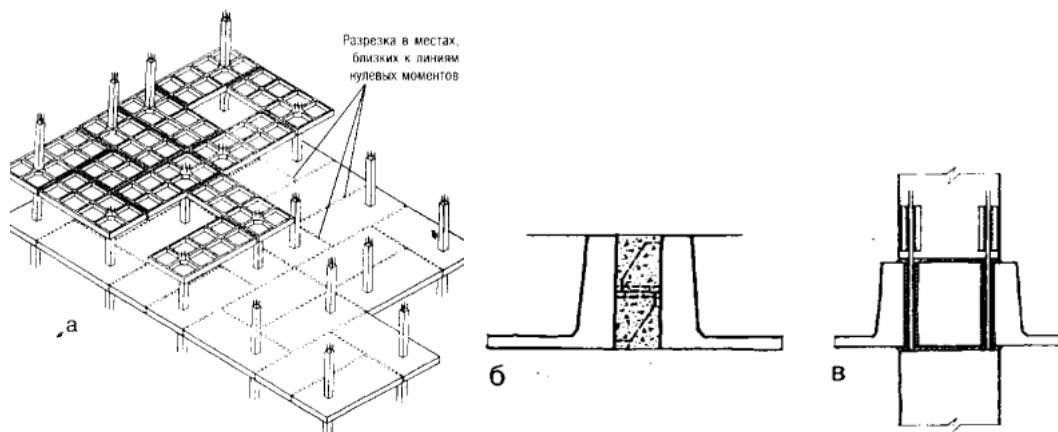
Монтажна схема безригельного каркасу: а – раскладка плит; б – стик колон; в – стик плит (панелей)
